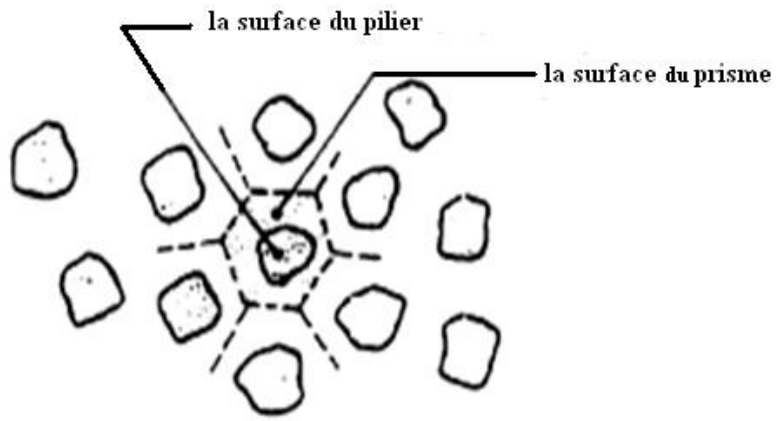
Figure XLIV: Piliers irréguliers à section droite plus ou moins circulaire montrés en plan [13]
